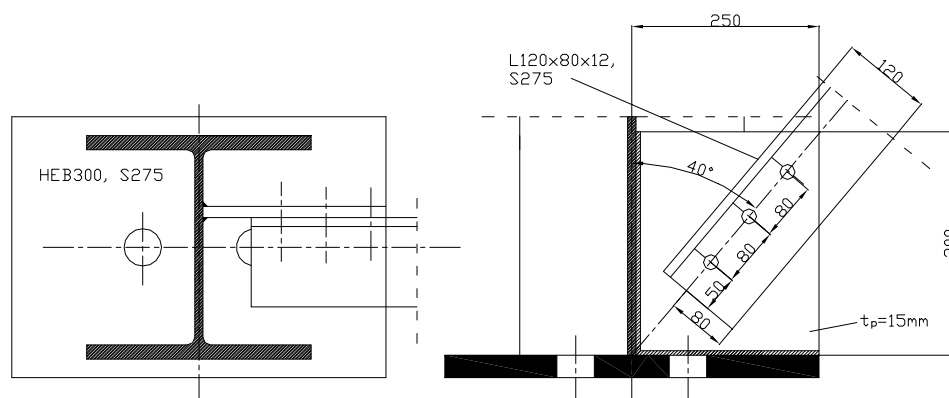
Detalle de la conexión por tornillos: planta y alzado
